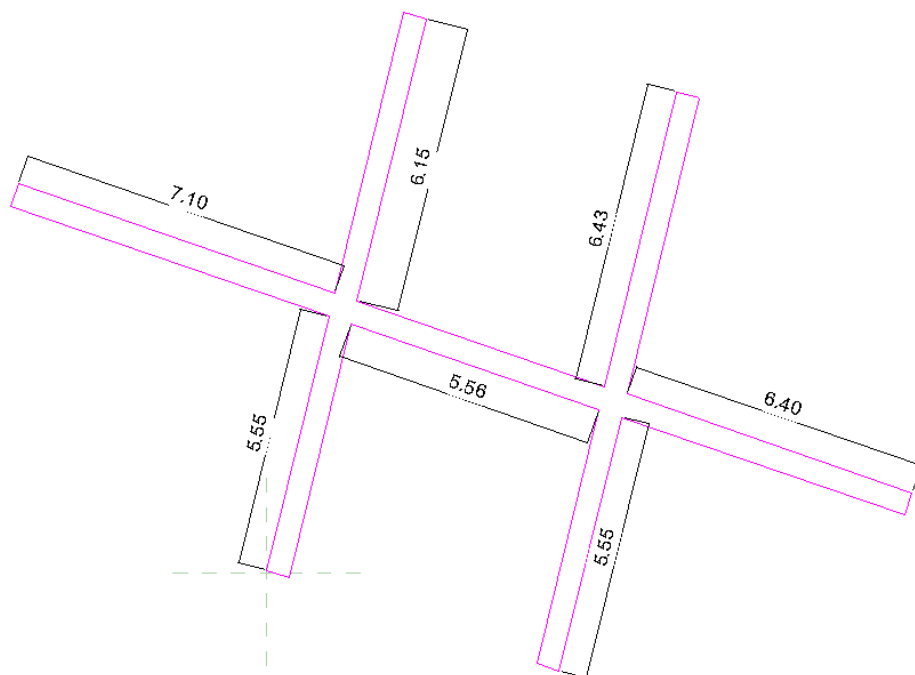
Extrusión de la geometría del pórtico Emparrillado_P-1. Fuente: Elaboración Propia.
